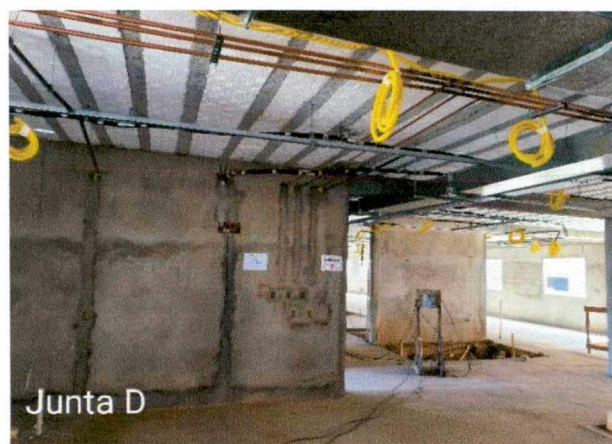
a 9: Execução de instalações (climatização, incêndio e gases medicinais), execução de reboco das calhas; impermeabilização das calhas.
